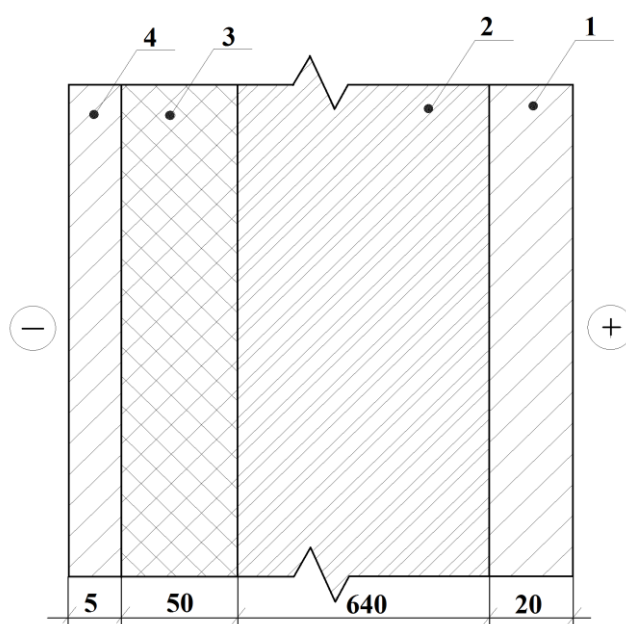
Конструкция наружной стены, утепленная с наружной стороны пеноплексом:
